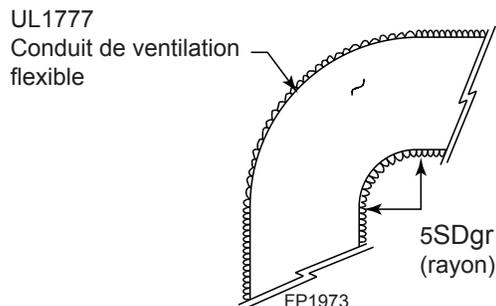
Rayon minimal par section de conduit de ventilation flexible
